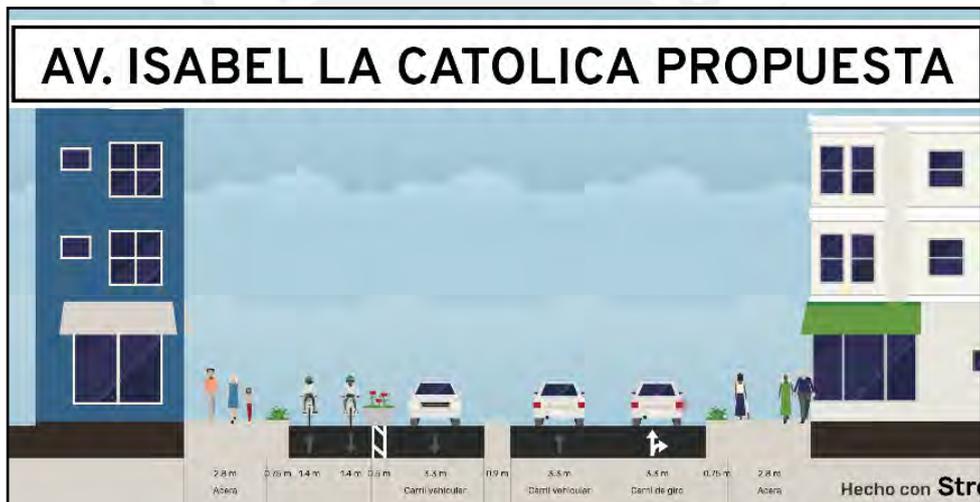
Vista en elevación de la situación propuesta en Av. Isabel La Católica.
